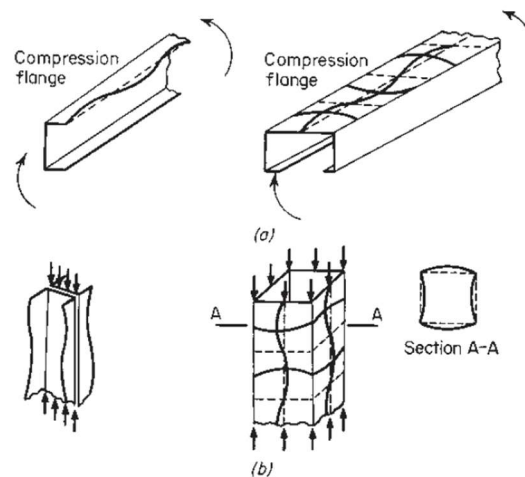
Pandeo local de miembros en compresión. (a) Vigas. (b) Columnas.
